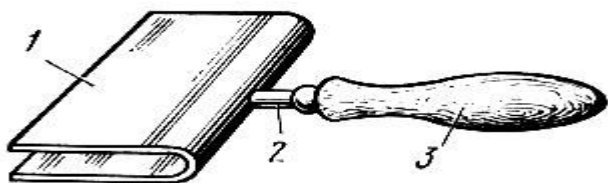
Захват для откалывания полос глазурованных плиток: 1 - стальная пластина, 2 - стержень-держатель, 3 - рукоятка
